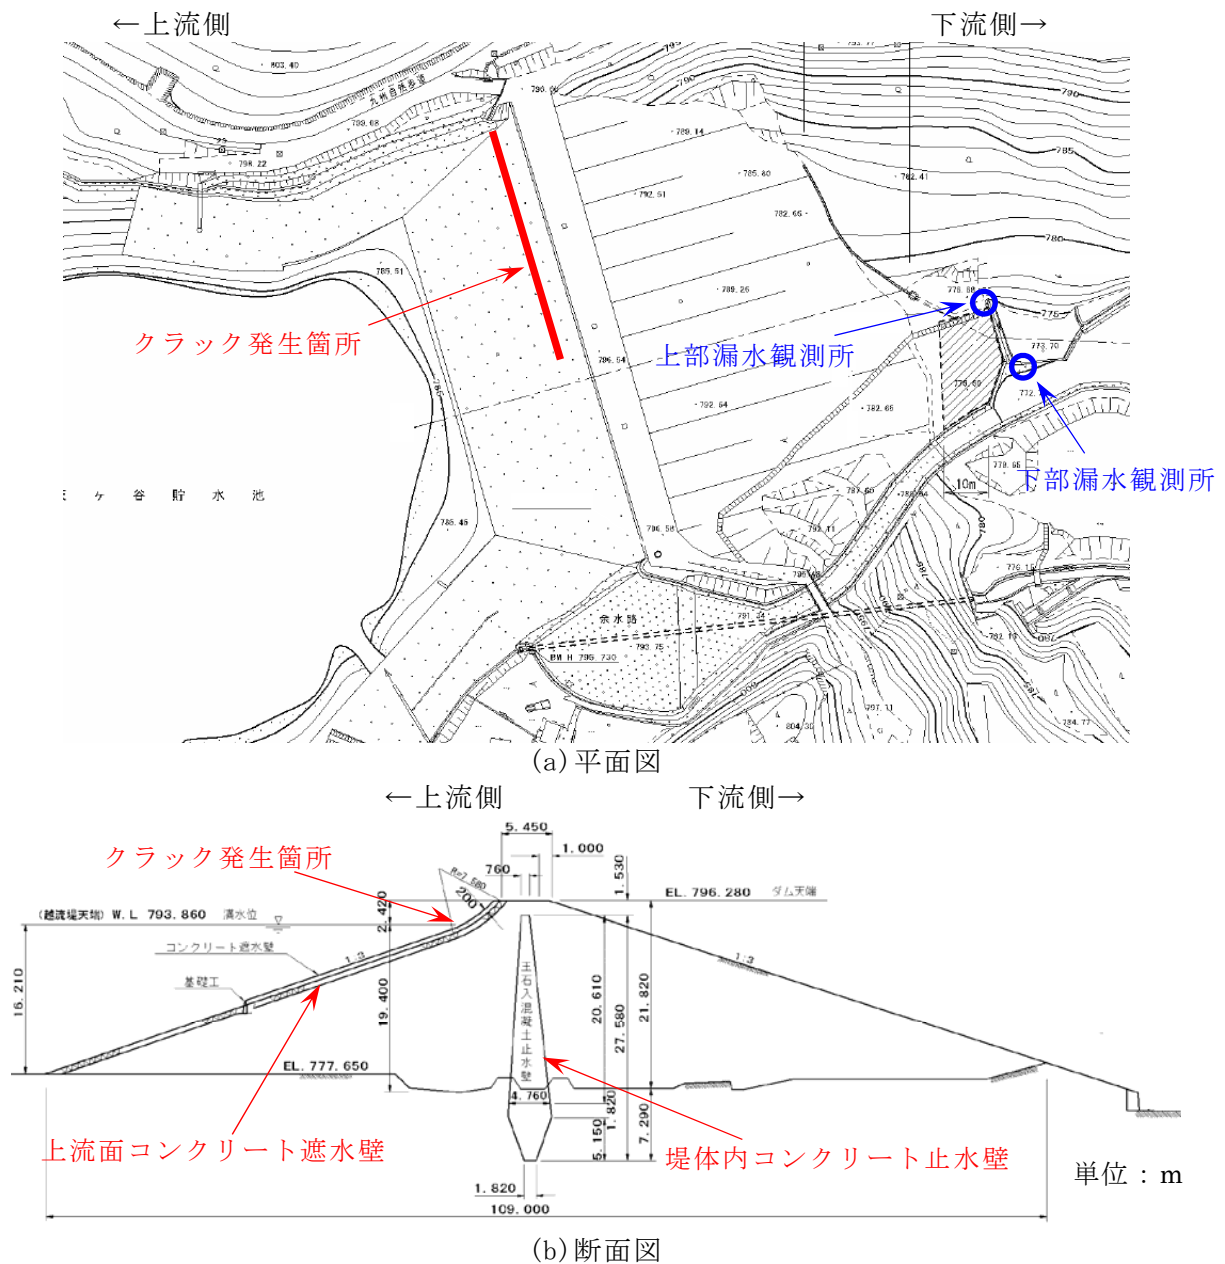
地蔵原ダムの平面図および断面図(九州電力(株)提供資料に一部加筆)
